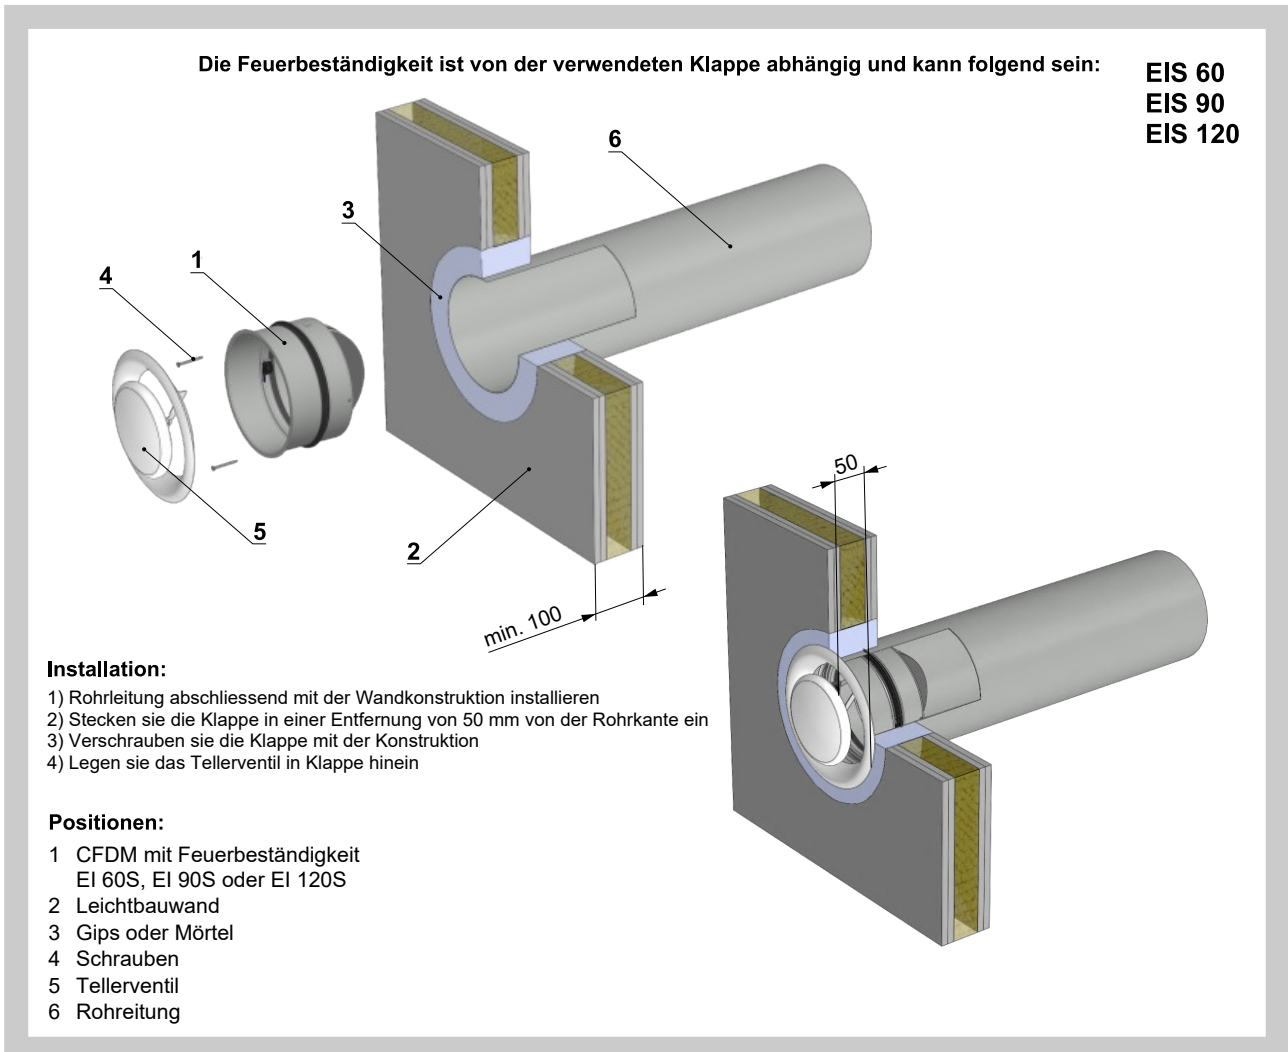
Installation der Klappe CFDM mit Tellerventil in eine Leichtbauwand
